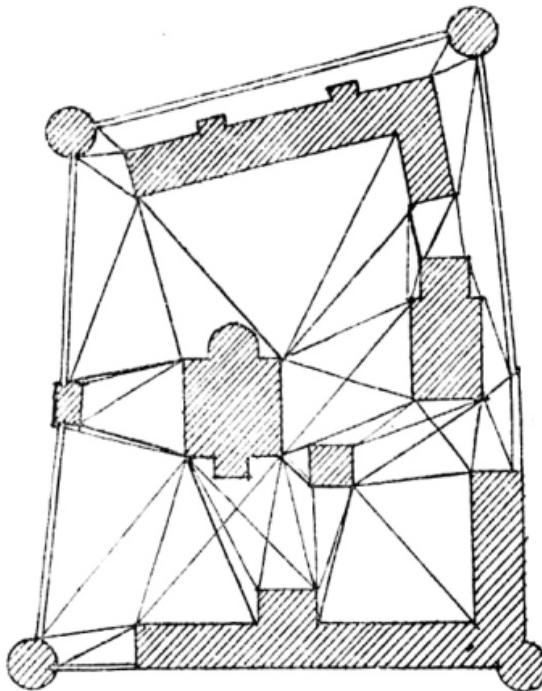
Обмеры генерального плана комплекса зданий засечками
